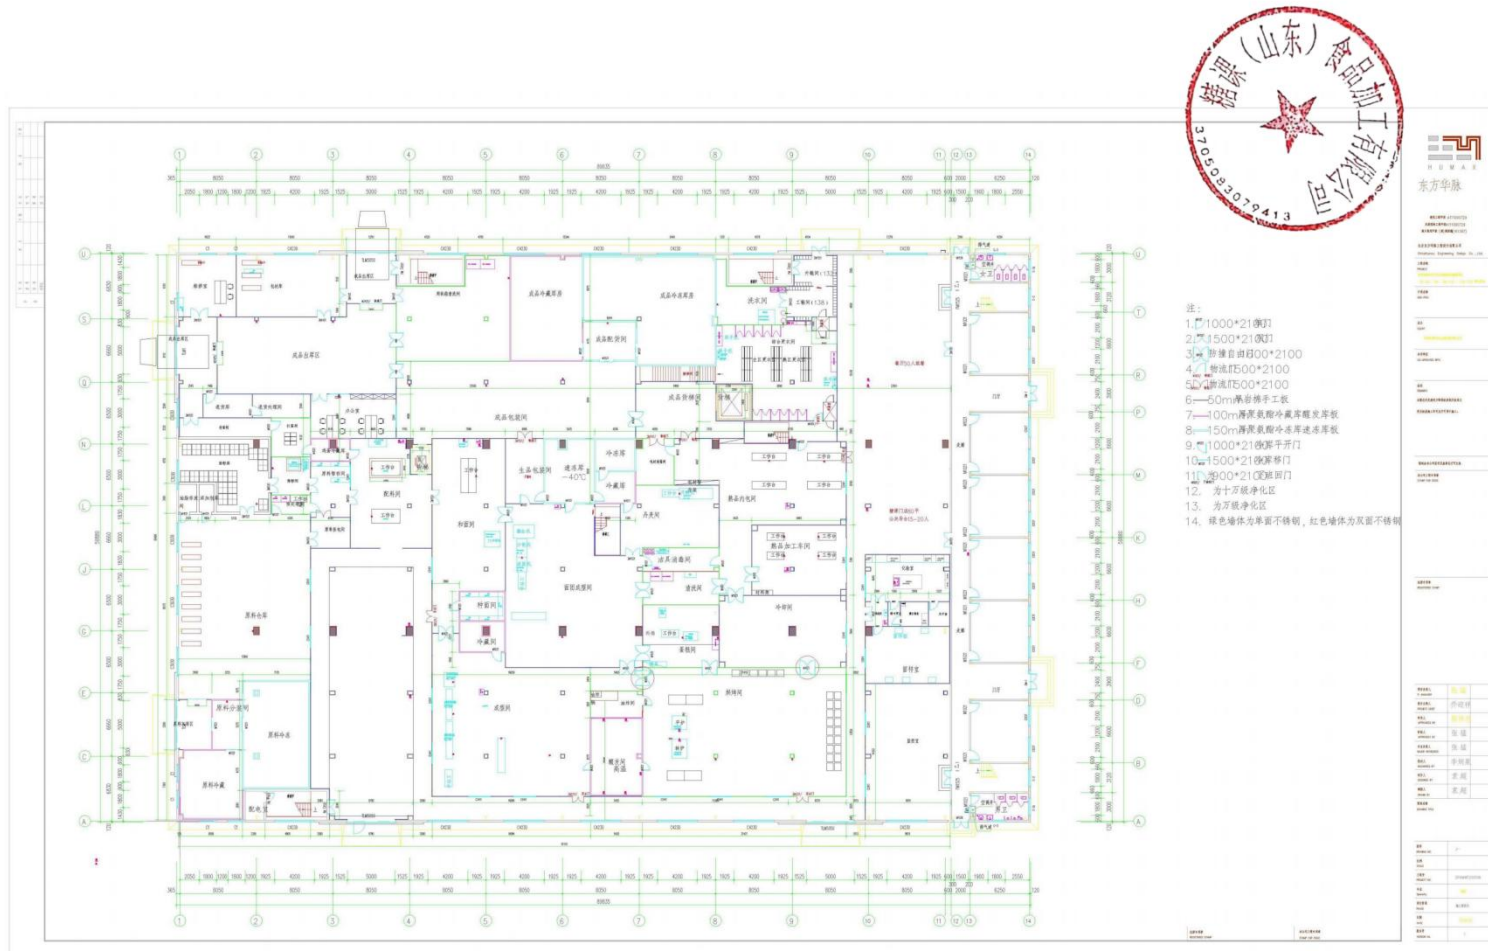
生产车间（1F）平面布置图 比例尺：1：2500
